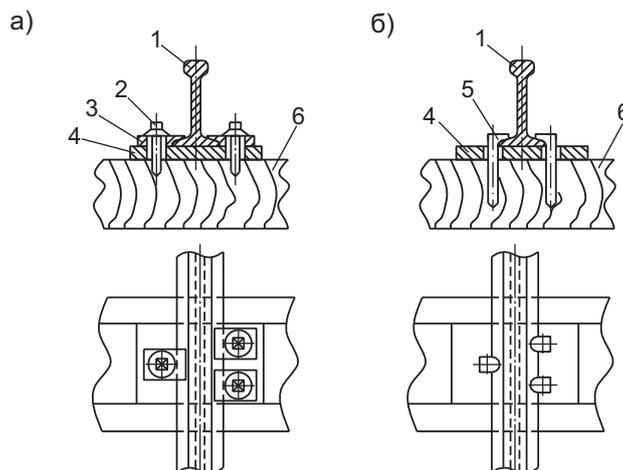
Прижим облегченный для крепления рельсов к полушпалам шурупами
